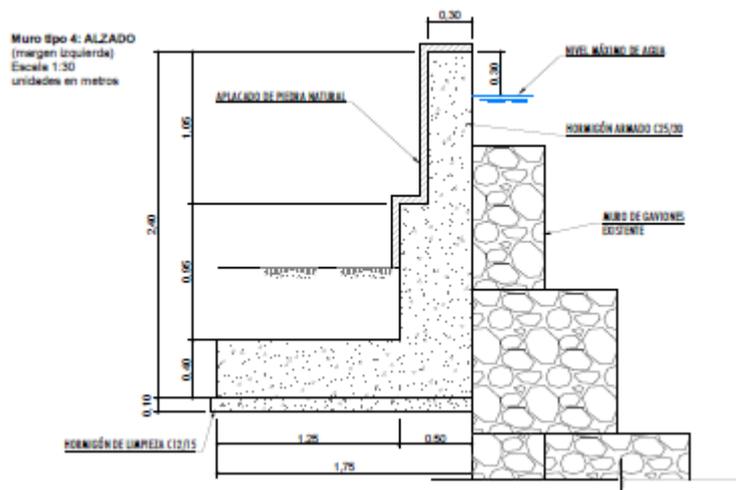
Recrecimiento del muro de gaviones existente en mi. Sección tipo
